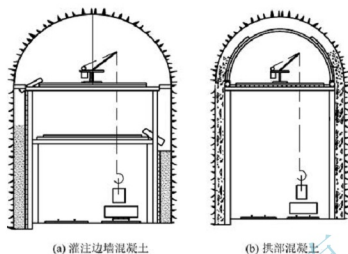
搭设工作平台灌注边墙混凝土和拱部混凝土
